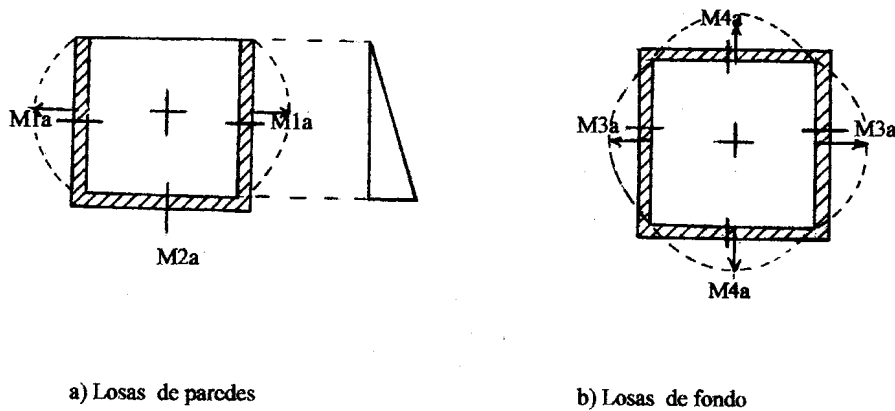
Esquemas de análisis correspondiente a losas aisladas de paredes y de fondo
